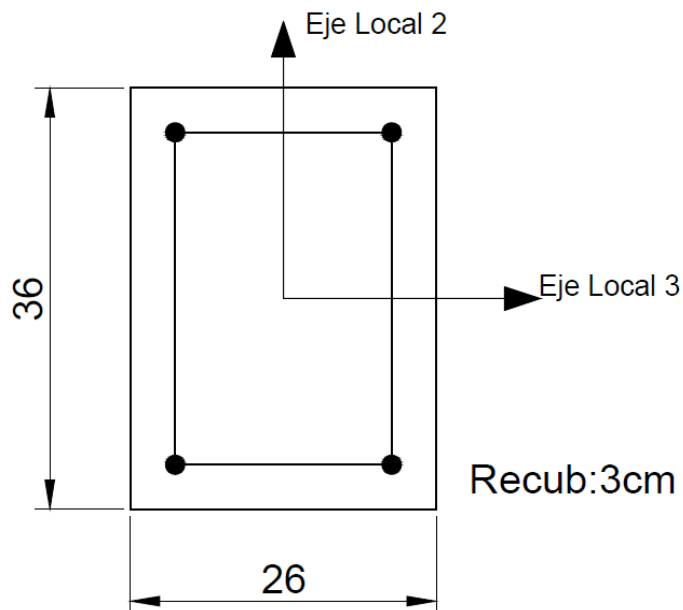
Sección de la columna donde se referencian los ejes locales utilizados en el RAM Advance
